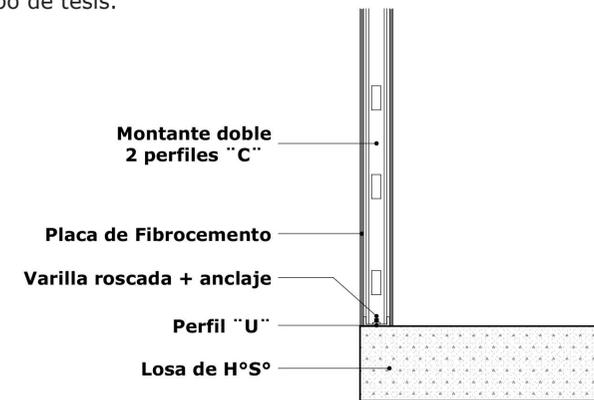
Detalle de unión, tabiquería - losa
